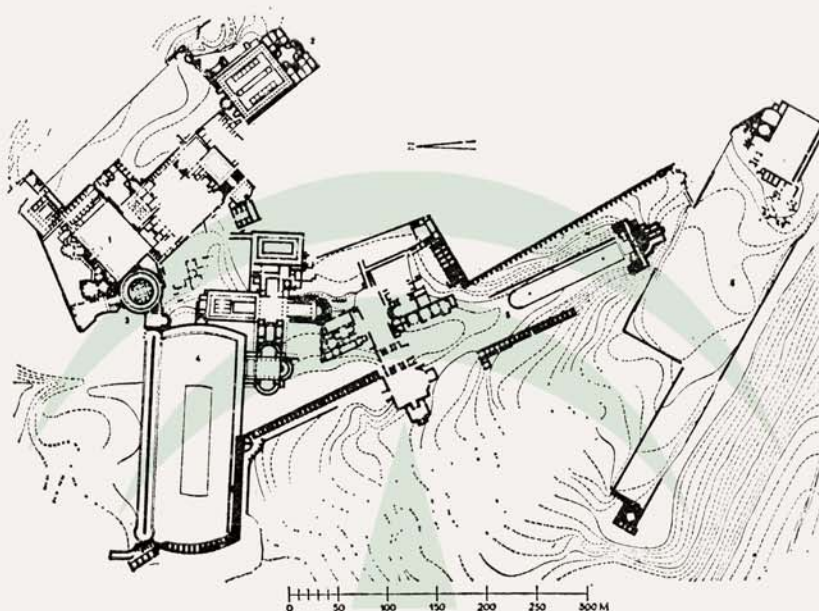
Tívoli: Villa de Adriano, planta del conjunto
